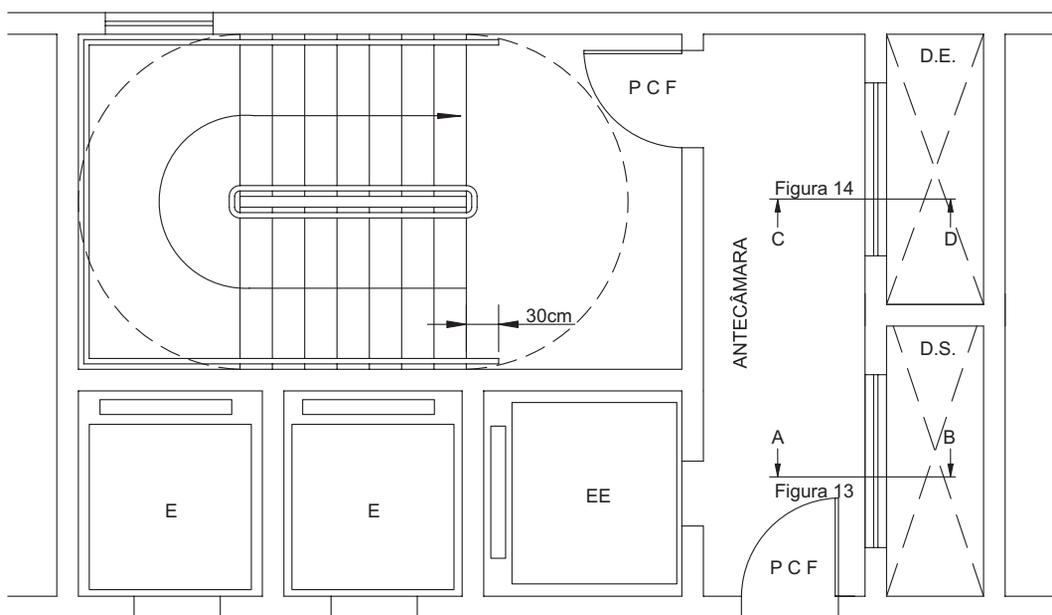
Escada enclausurada à prova de fumaça com elevador de emergência (a posição deste é somente exemplificativa) na antecâmara
